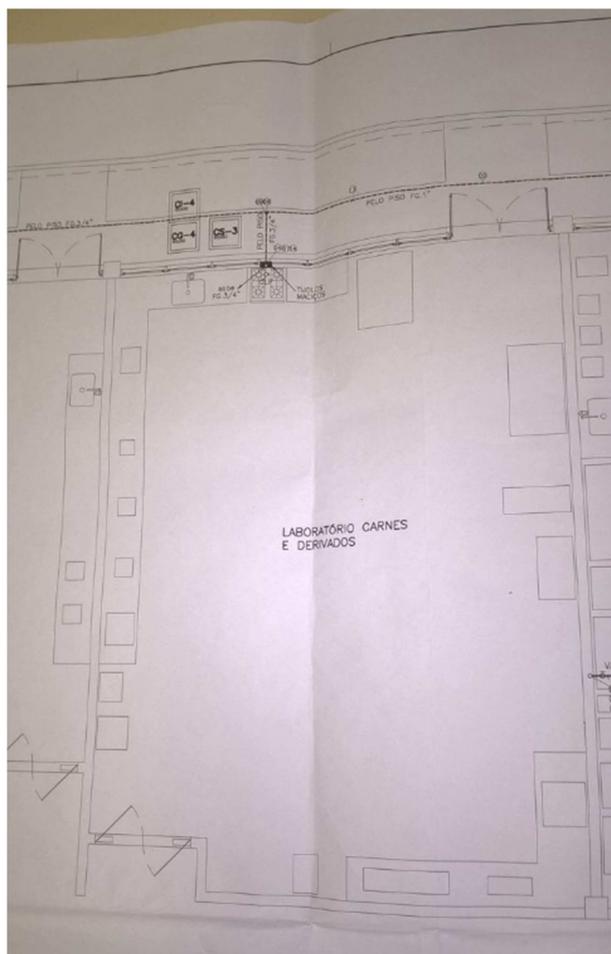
Planta baixa da Planta Piloto de Produtos Cárneos e Base Lipídica
